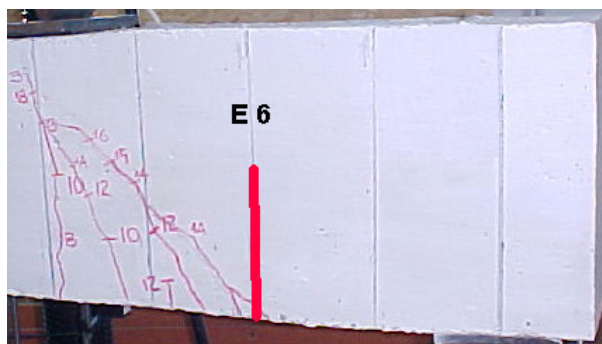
Detalhe da fissuração em E6 e posição dos extensômetros
